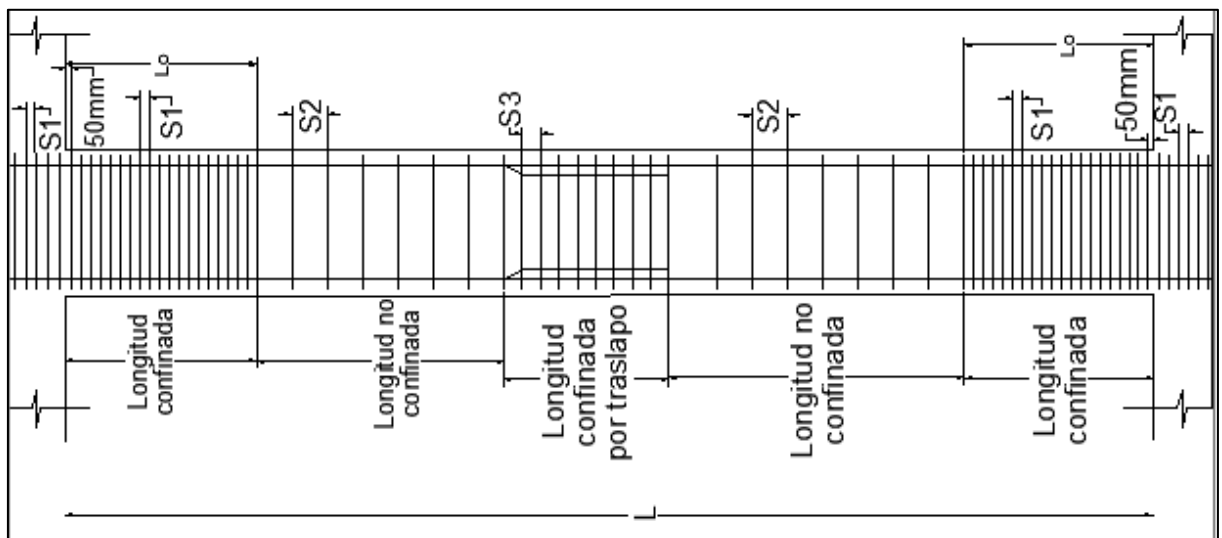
Separación Geométrica de los estribos cerrados de confinamiento columnas.
